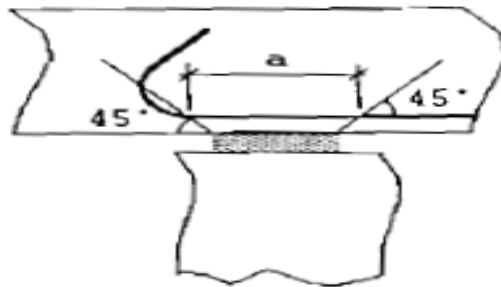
Largeur de bielle « poutre à nervure sur appareil d'appui » [1]
